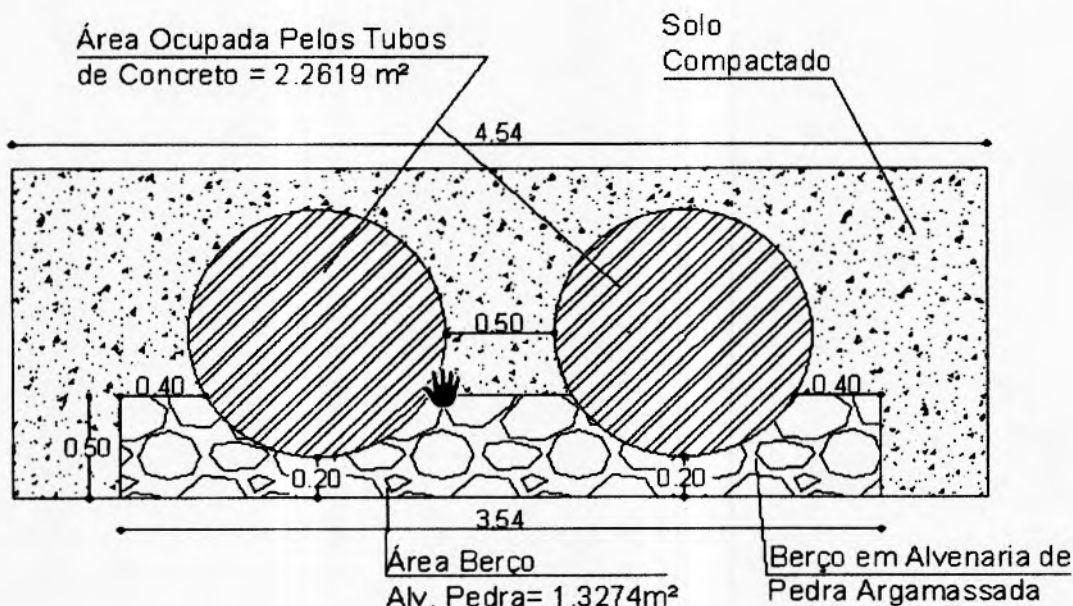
Corte Tubos de Concreto e Berço em Alvenaria de Pedra Argamassada
